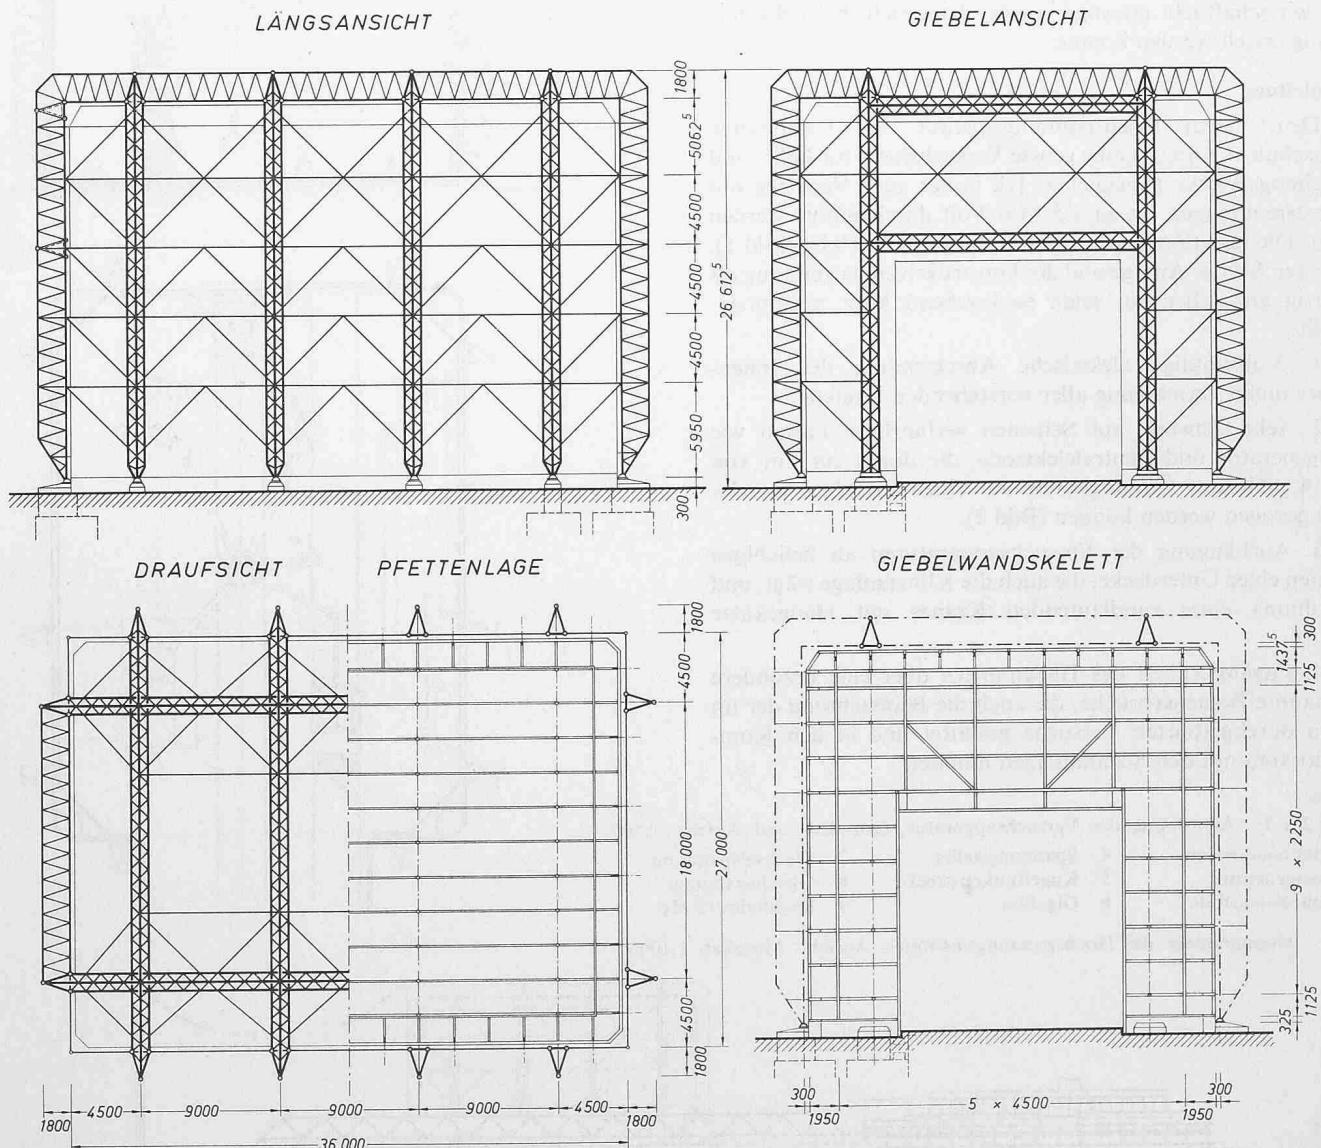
Generelles Projekt der Stahlkonstruktion der grossen Versuchshalle, Massstab 1:500
